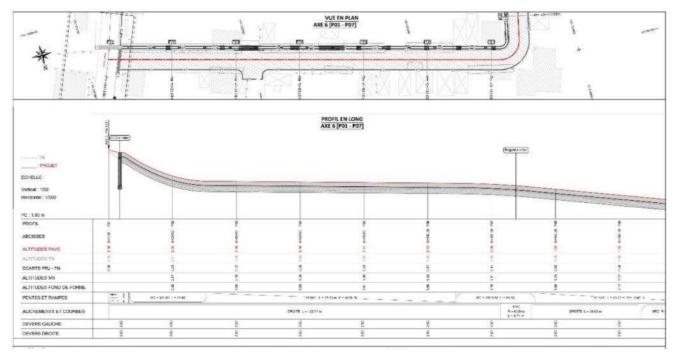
Tracé en plan et profil en long Axe 6 - Chaussée autobloquant
